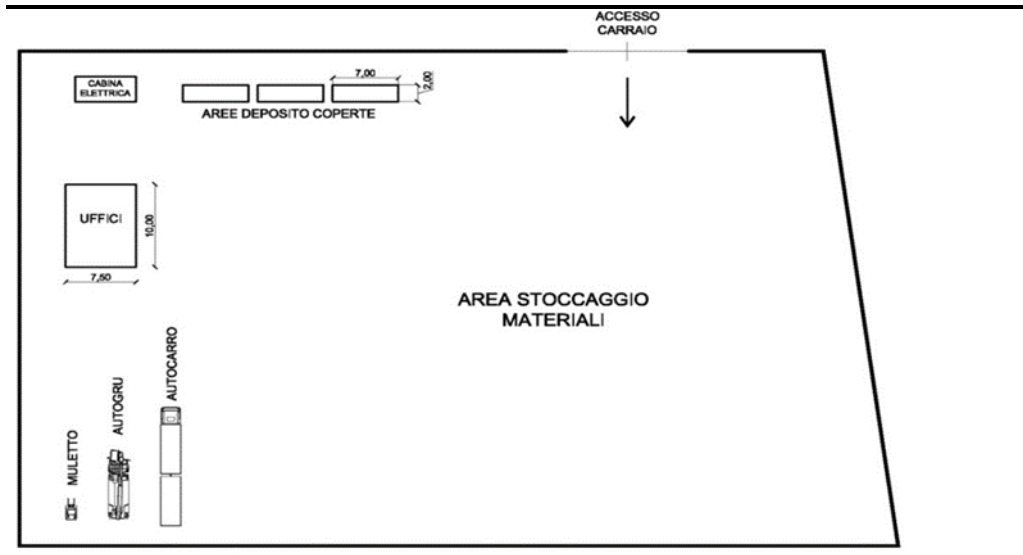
Tipologico di Planimetria dell'Area Sostegno (scavo di fondazione - getto e basi)
